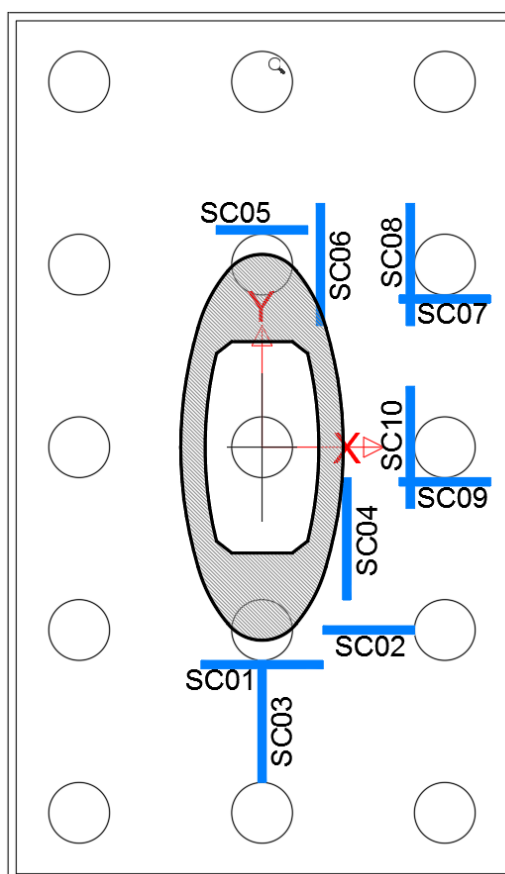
Localizzazione planimetrica delle sezioni di verifica prese in esame.
